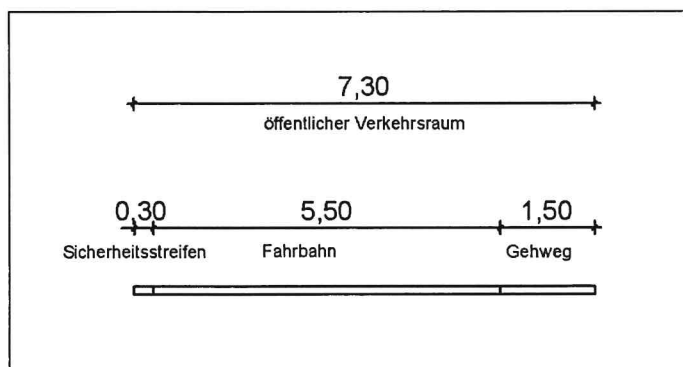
Querschnitt II (Planstraße B – F, H)
